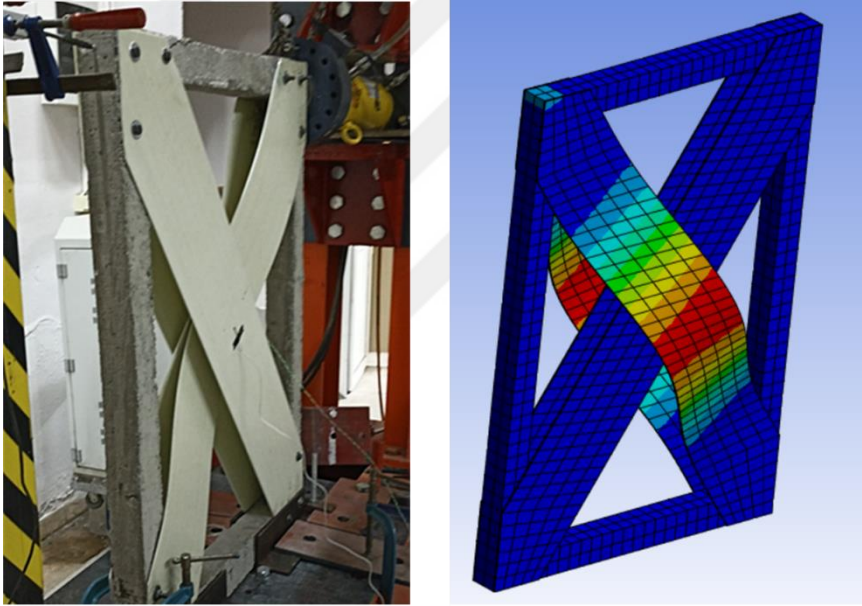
Deneyel ve nümerik betonarme çerçeve modellerin doğrulanması
